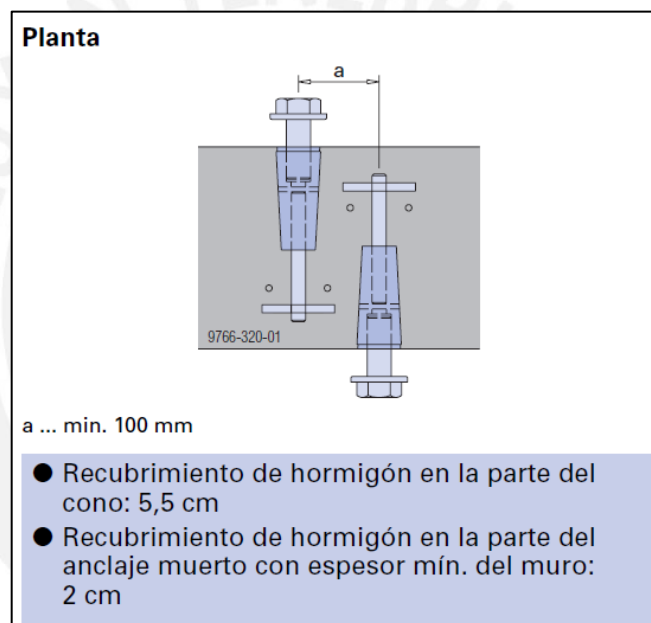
39 Vista en planta de anclajes del Sistema ATR. (Doka Perú SAC, 2008)
